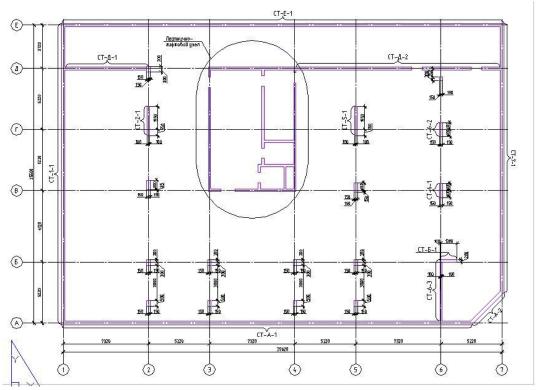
Схема монолитных конструкций подвала Надземная часть, плиты перекрытий и покрытия (рисунок Б.5):
